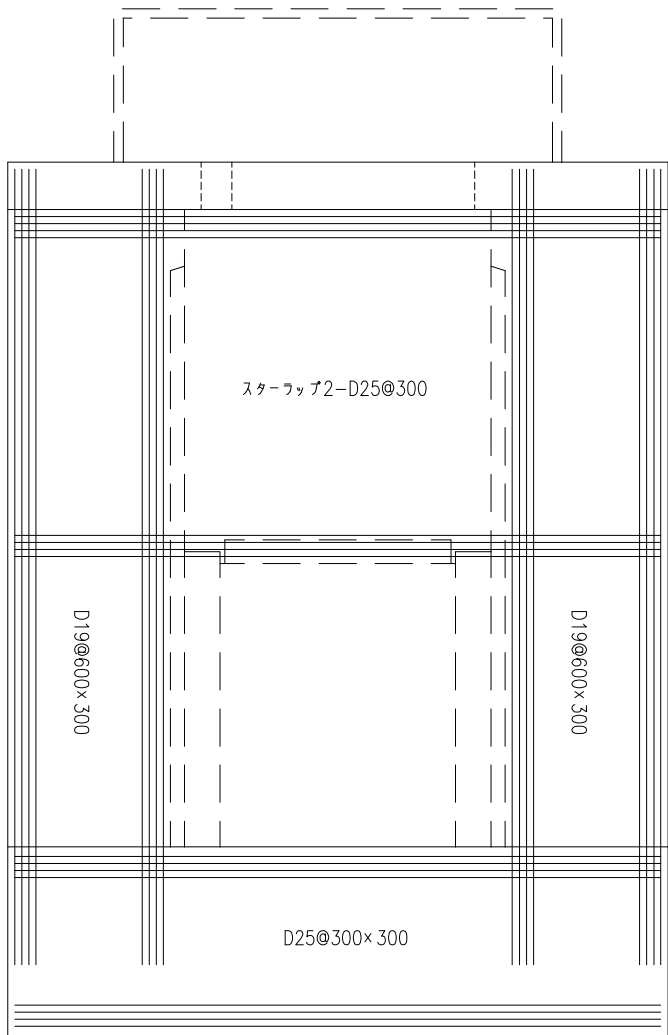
概略せん断補強筋配置図 (B-B断面)
